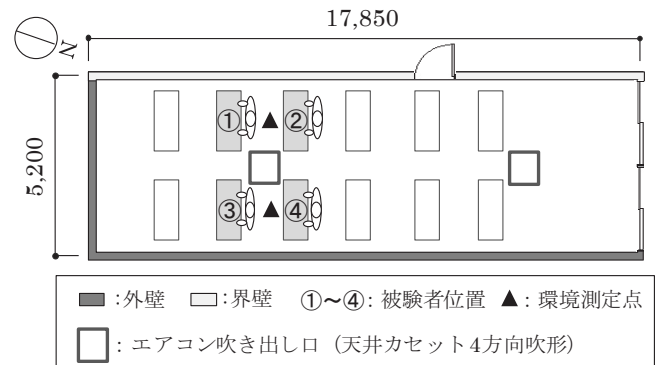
作業空間の平面図と物理環境測定点 (単位・mm)
